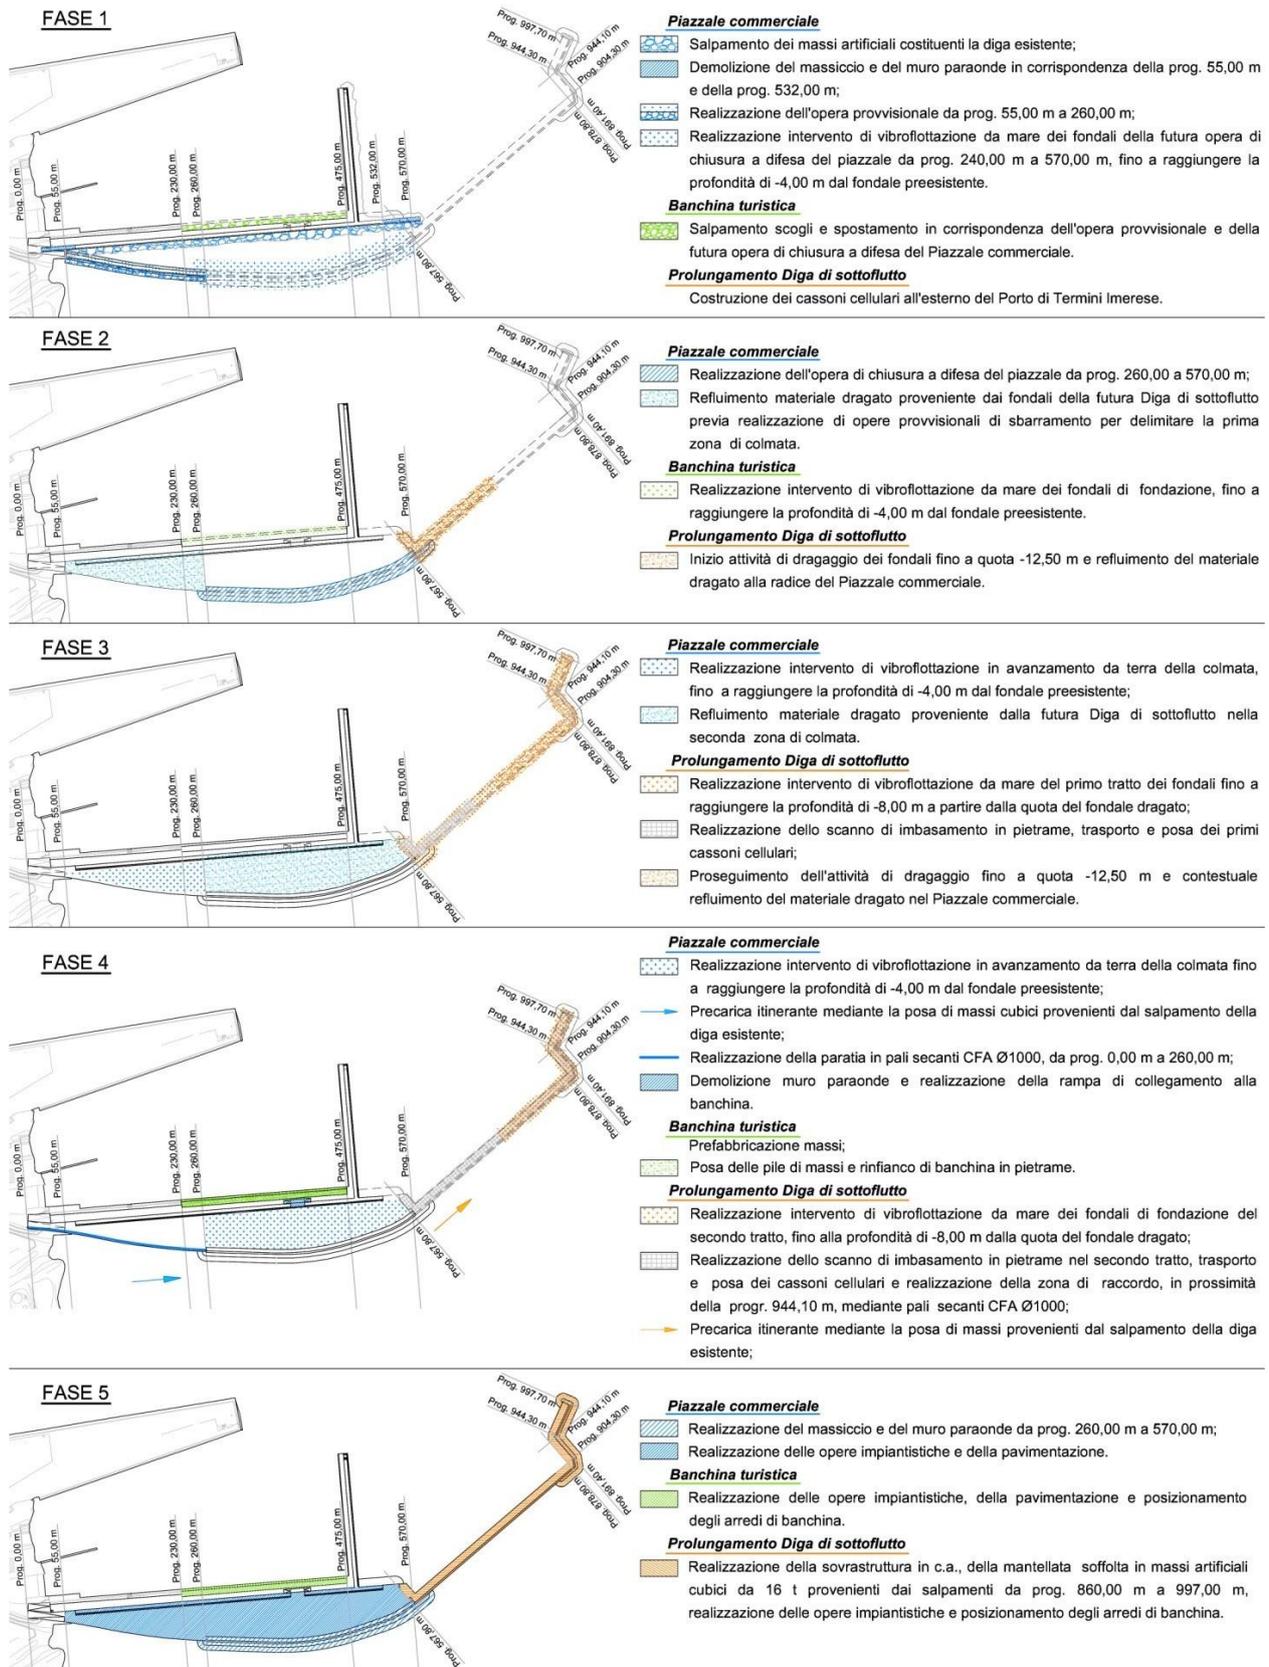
Fasi dell'avanzamento dei lavori per la realizzazione del molo si sottoflutto estratto dal Progetto Esecutivo in Variante al Progetto Definitivo
